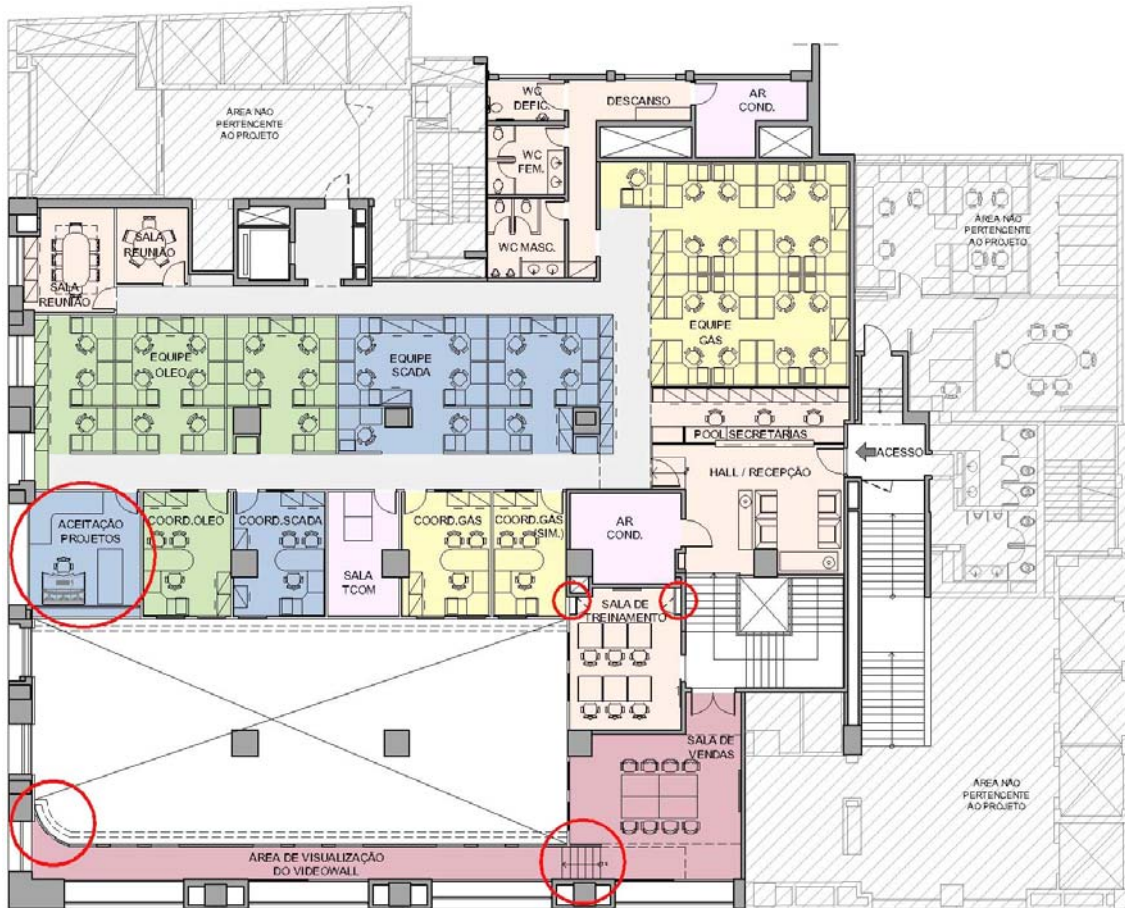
Planta baixa mezanino: layout apresentado na revisão do *milestone* 3
